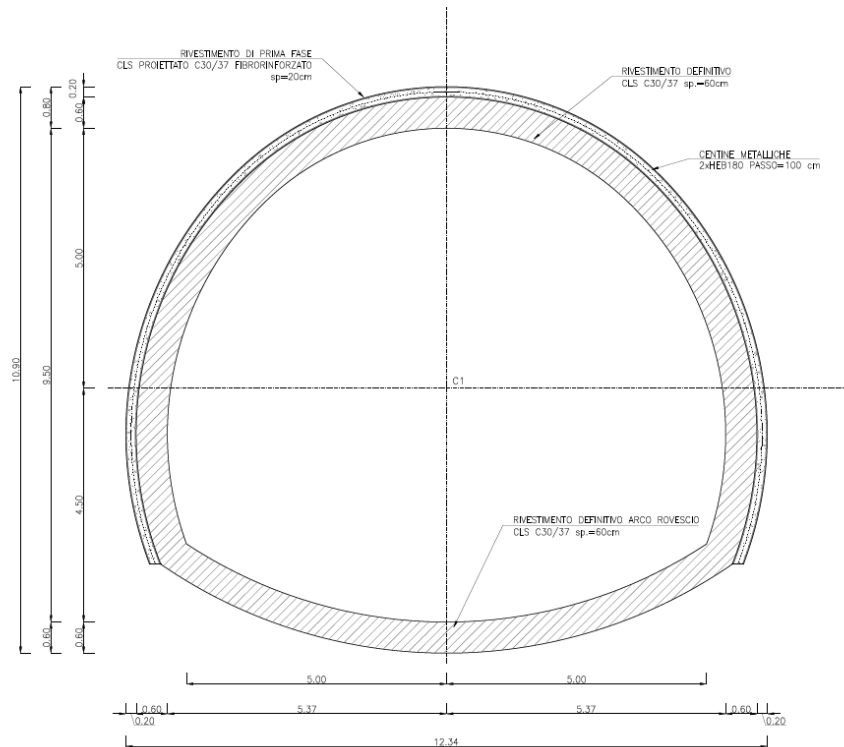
Sezione tipo D2: geometria del cavo e interventi di sostegno
